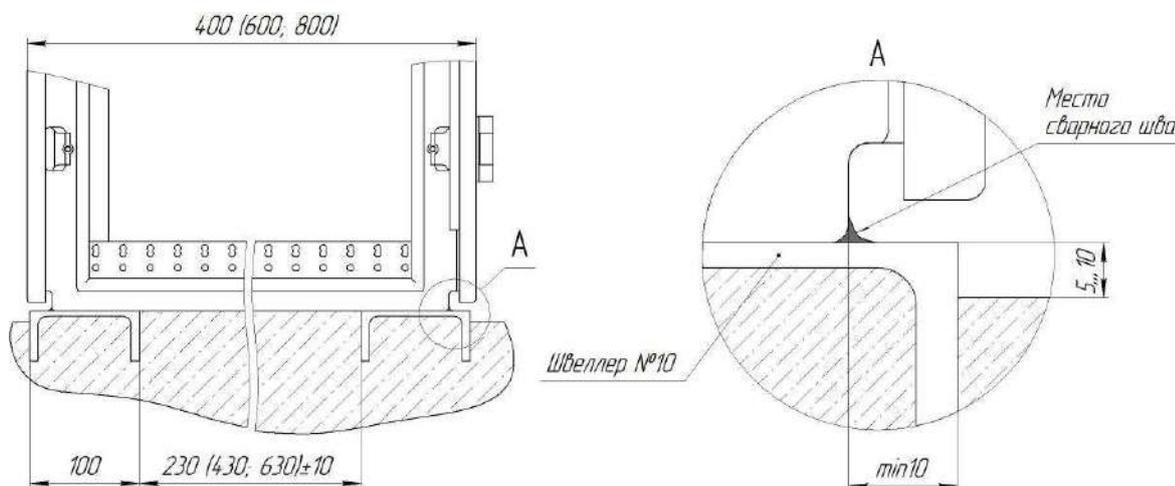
Крепление ШСП к закладным элементам при помощи сварки
